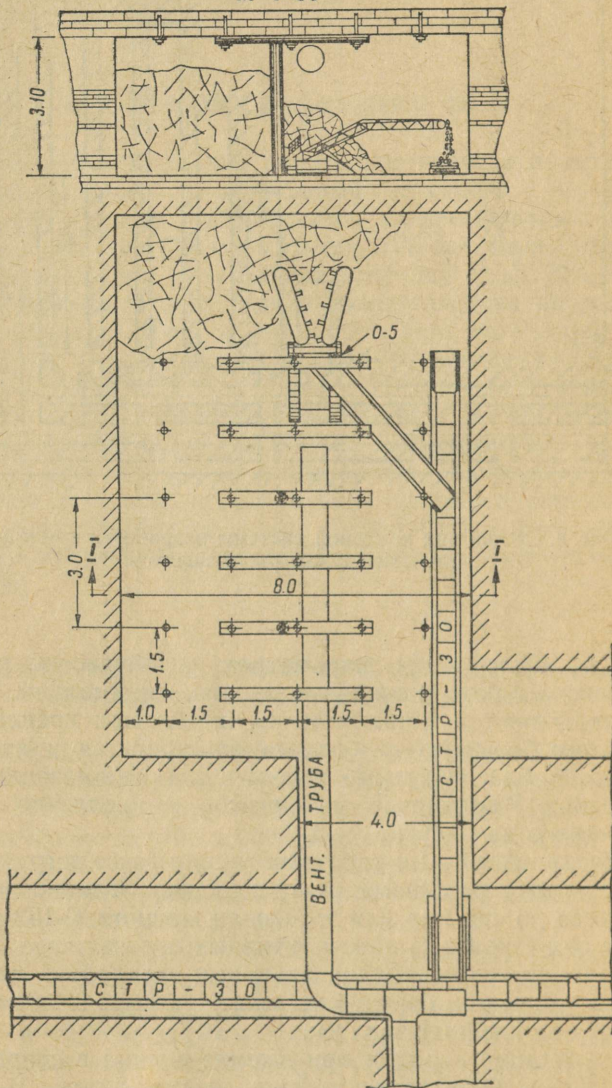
Схема крепления кровли и размещения механизмов в камере.
